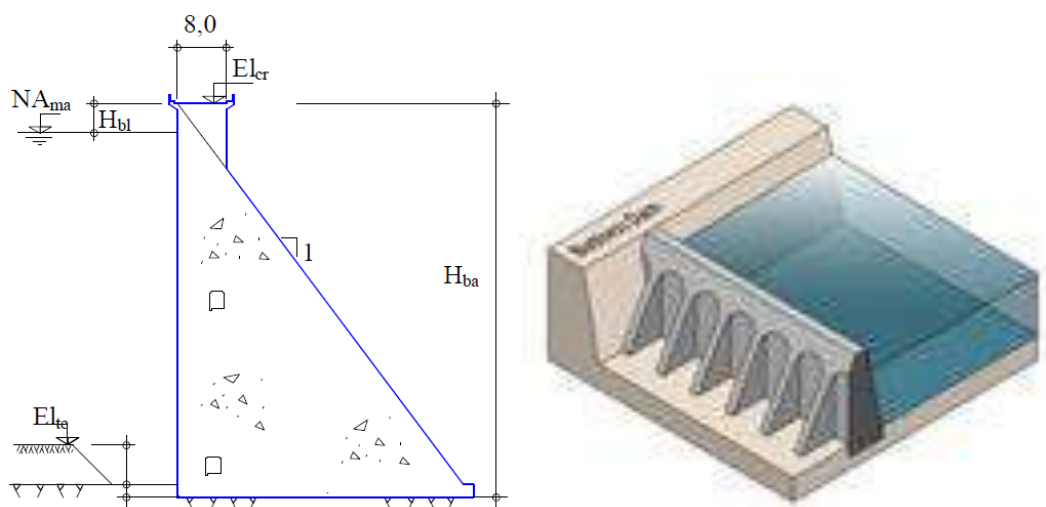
Seção tipo barragem de concreto gravidade e com contraforte.
